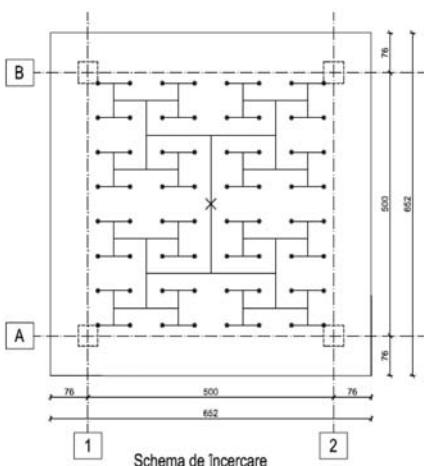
Schema de încărcare pentru placă Bubble Deck
